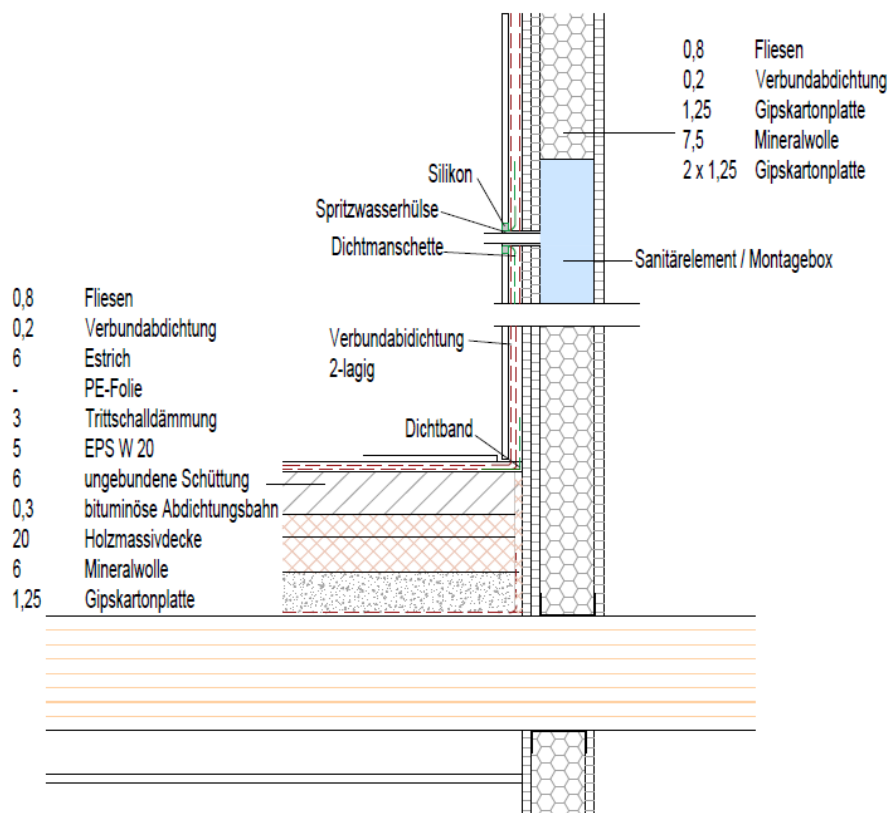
Vertikalschnitt der Rohrdurchführung für Sanitärinstallationen
